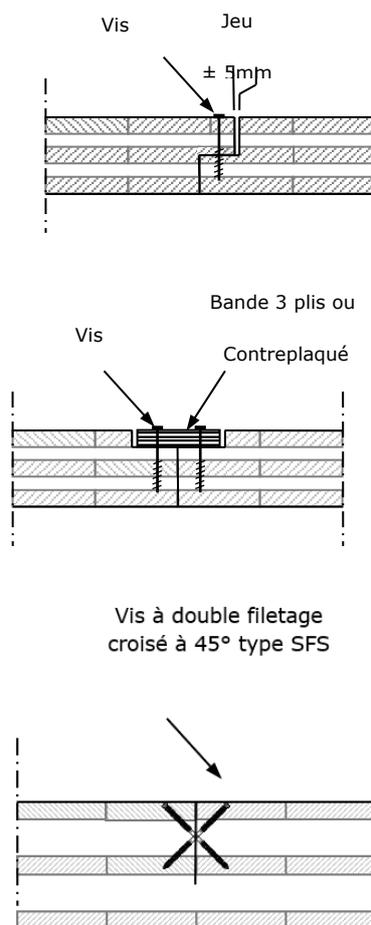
jonctions courantes entre panneaux de plancher ou de murs
